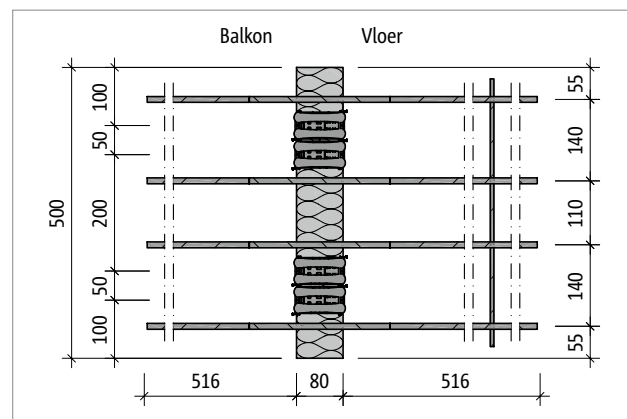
Schöck Isokorf® T type Q-E-V5 bij R0: Zijaanzicht
